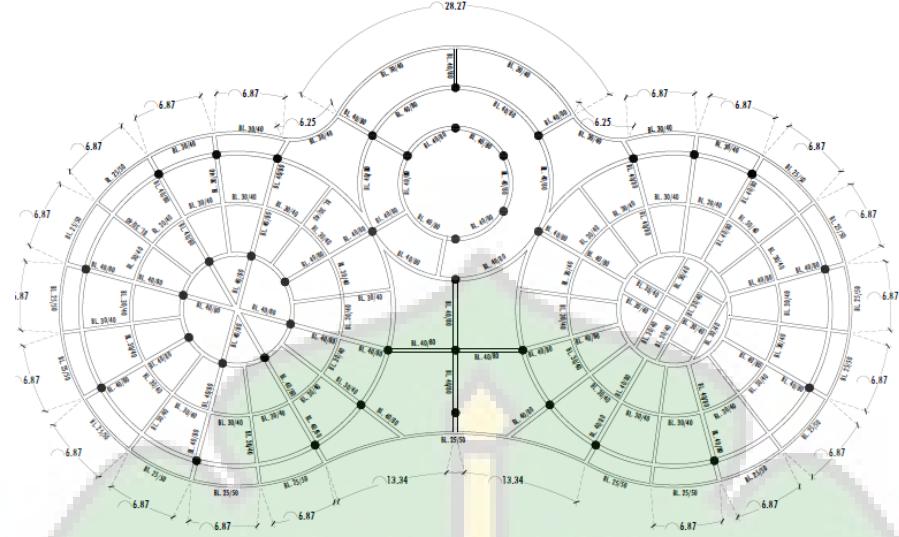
Denah Rencana Balok Lantai 2
